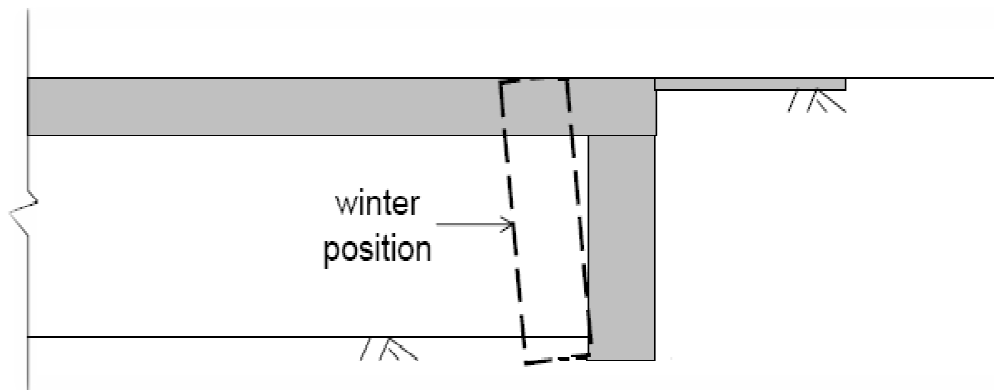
Movimenti delle spalle in seguito all'accorciamento della sovrastruttura (Horvath, 2000)
